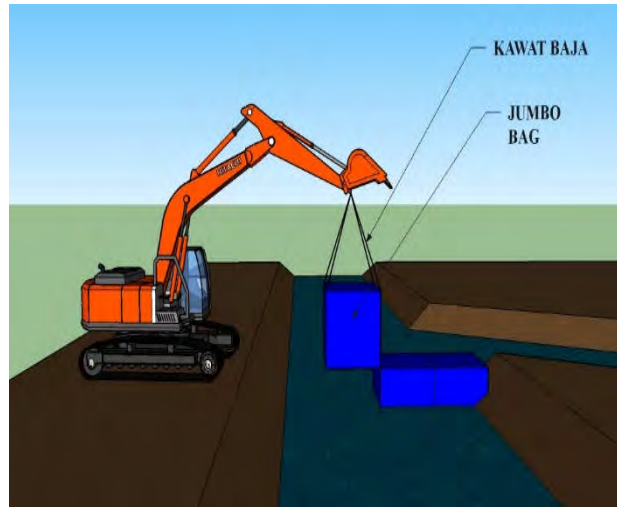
39. *Jumbo bag* dan *steel sheet pile* telah terpasang di bendung pengelak hulu
